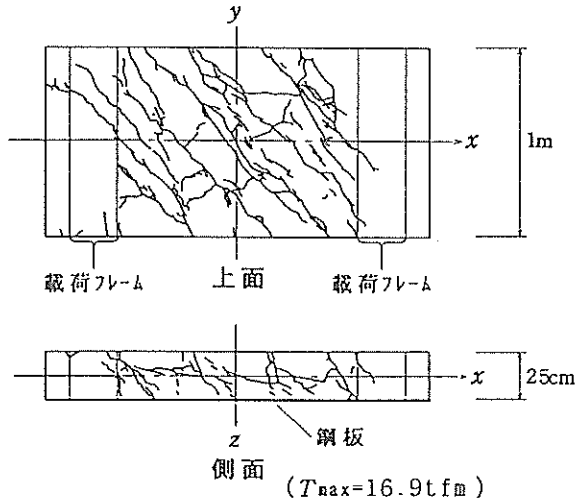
供試体 OS-19-150のひび割れ発生位置
